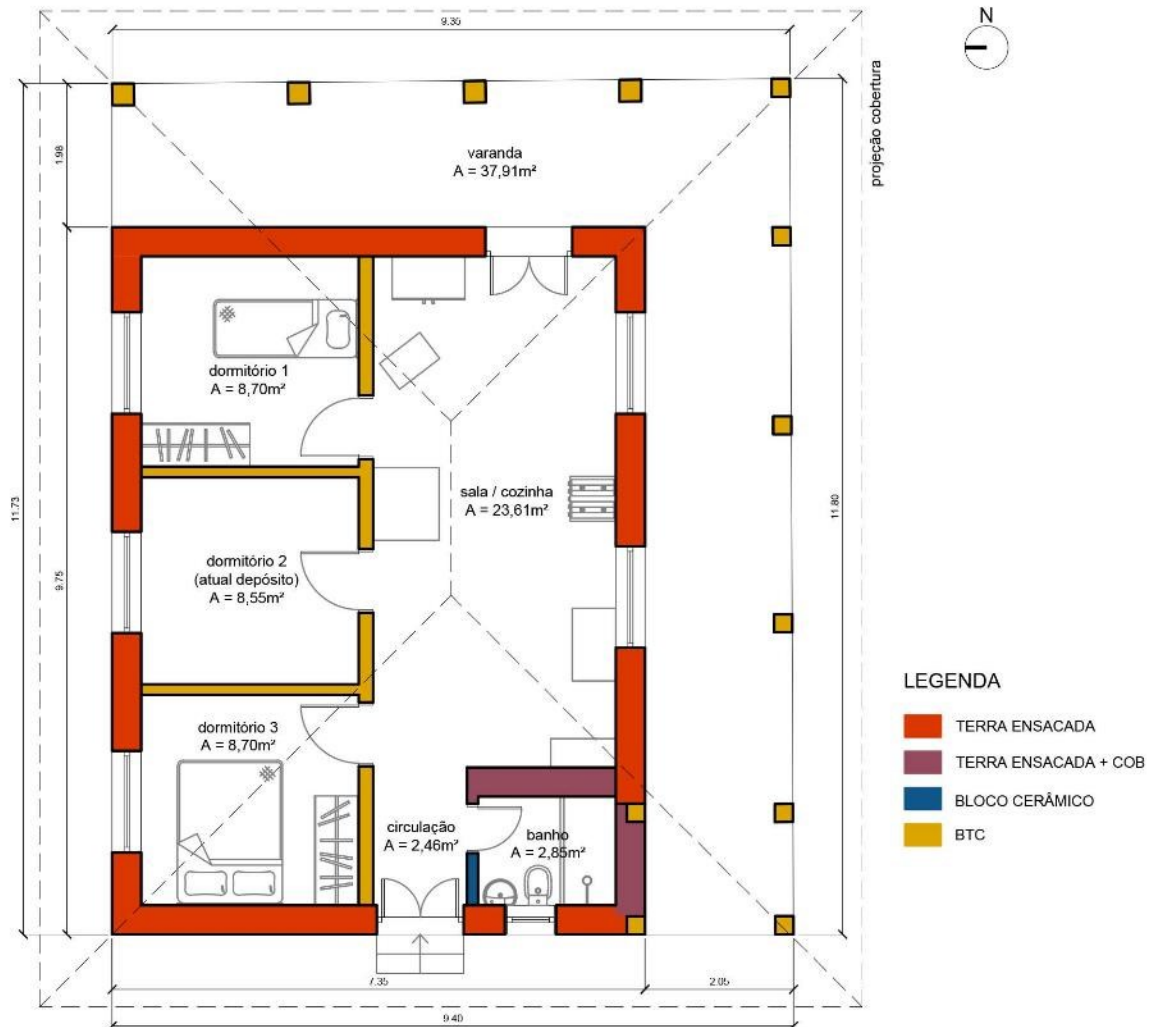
Planta baixa Edificação 02 (PROMPT, 2012)
